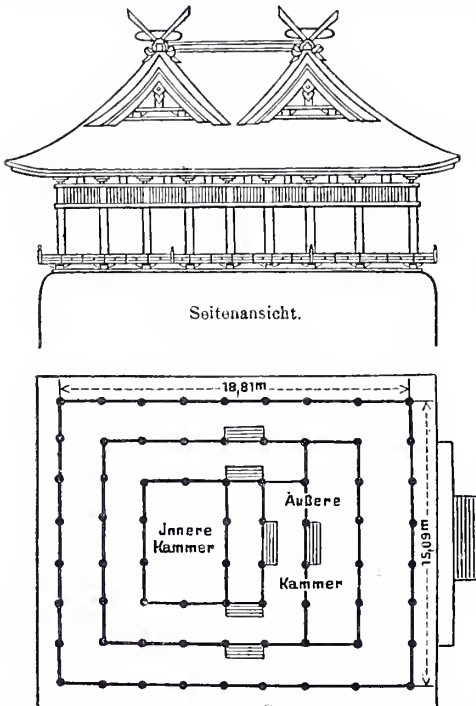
Grundriß und Seitenansicht des Kibitsu-jinja bei Okayama. Nach F. Walzer.
